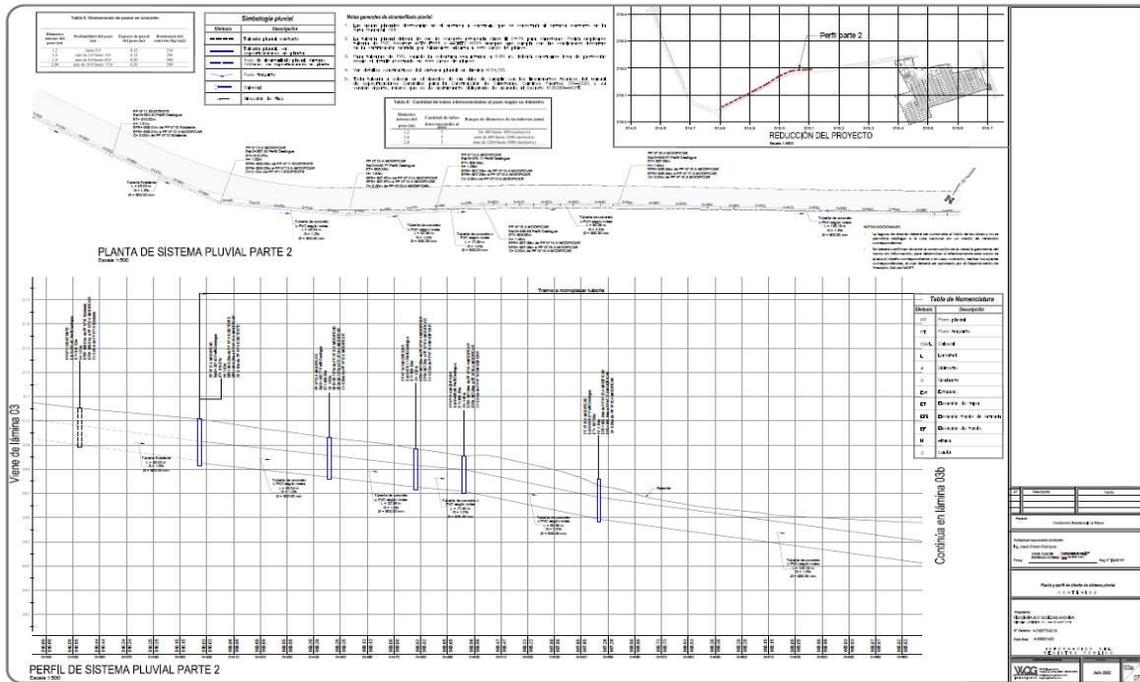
Trayecto de Tubería Pluvial sobre Ruta Nacional # 129, descarga en Río Segundo. (trayecto # II). Lámina Pluvial # 03b
